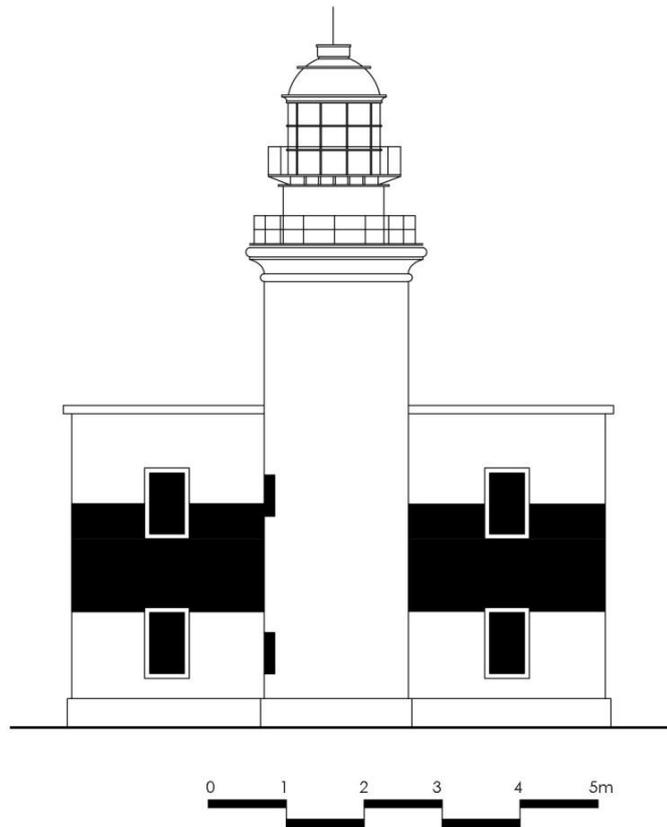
Esempio di faro a blocco con torre collocata lungo l'asse di simmetria. rielaborazione della pianta e prospetto del Faro di Capo dell'Arma, Sanremo, (IM).
